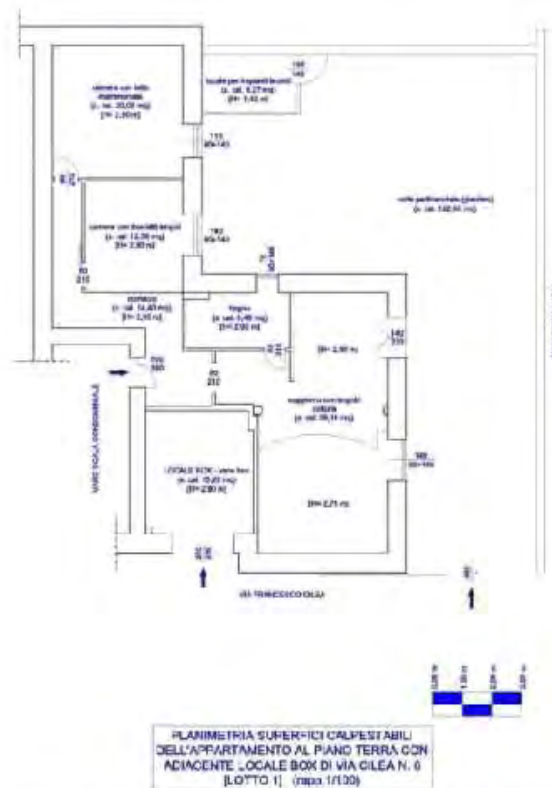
Planimetria urbanistica appartamento al piano terra con adiacente locale box (26.6.2018)
